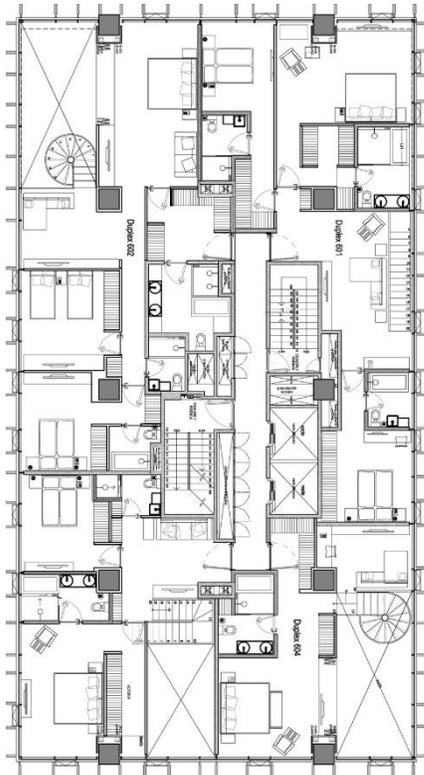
vista de planta baja de departamentos. Archidaily.com
